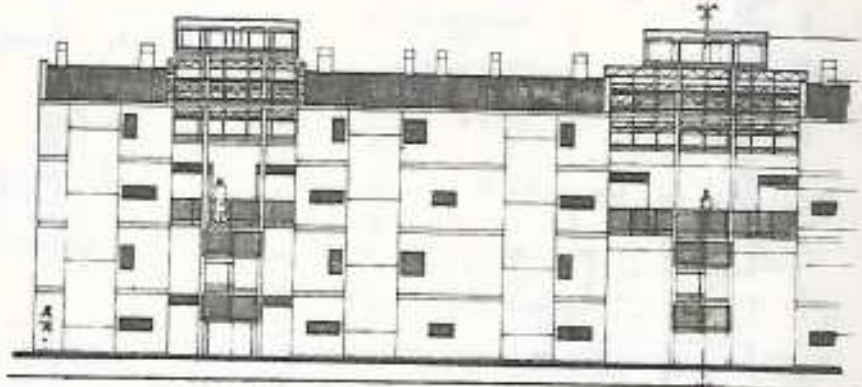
Fachada parcial Sur sub-conjunto 3
